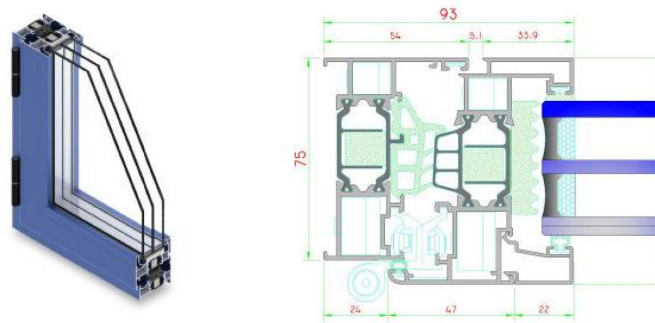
Carpinterías de fachada, triple acristalamiento con rotura de puente térmico.
